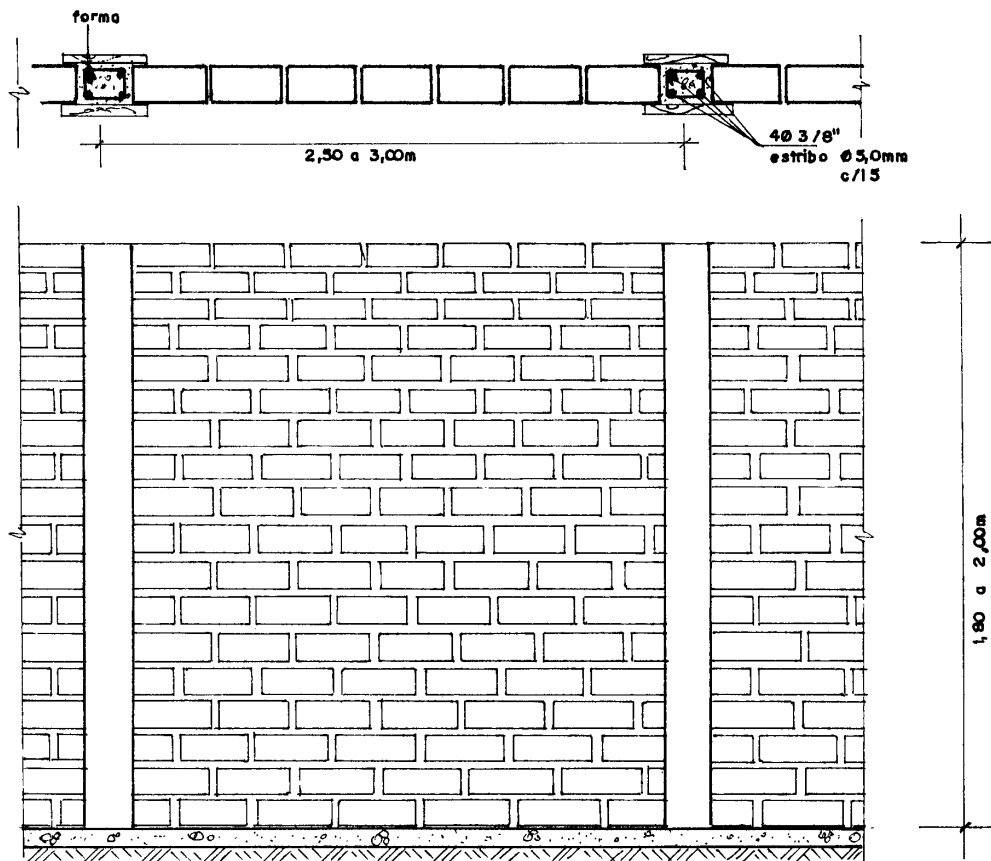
Detalhe de execução de um muro de tijolo maciço
